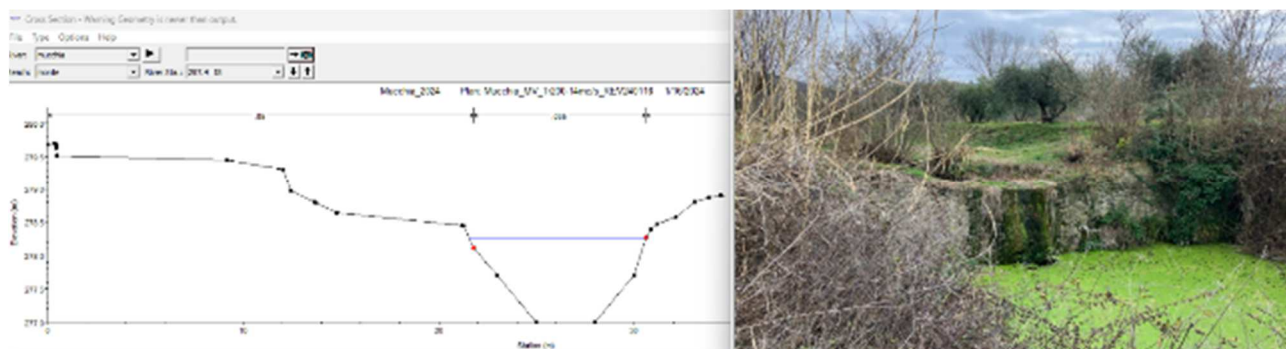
SEZIONE D'ALVEO A MONTE (VISTA DA MONTE) DELLA BRIGLIA IN PIETRA (FOTO VISTA DA VALLE)
